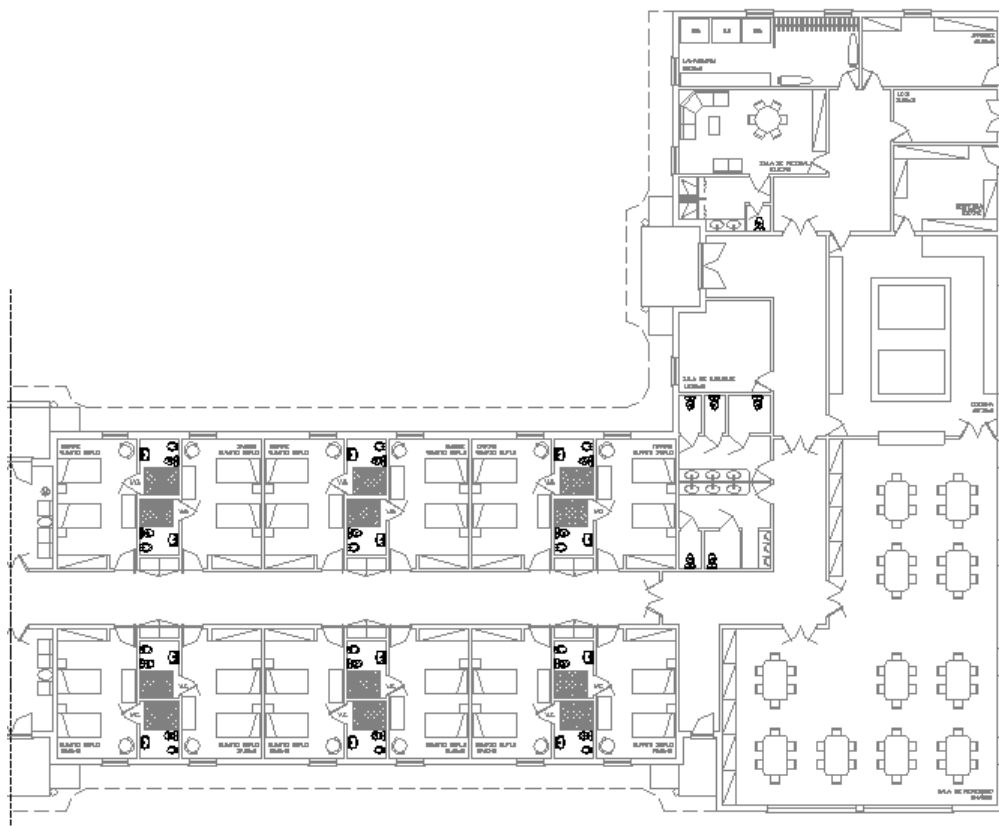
Detalhe vista em planta do estabelecimento.
